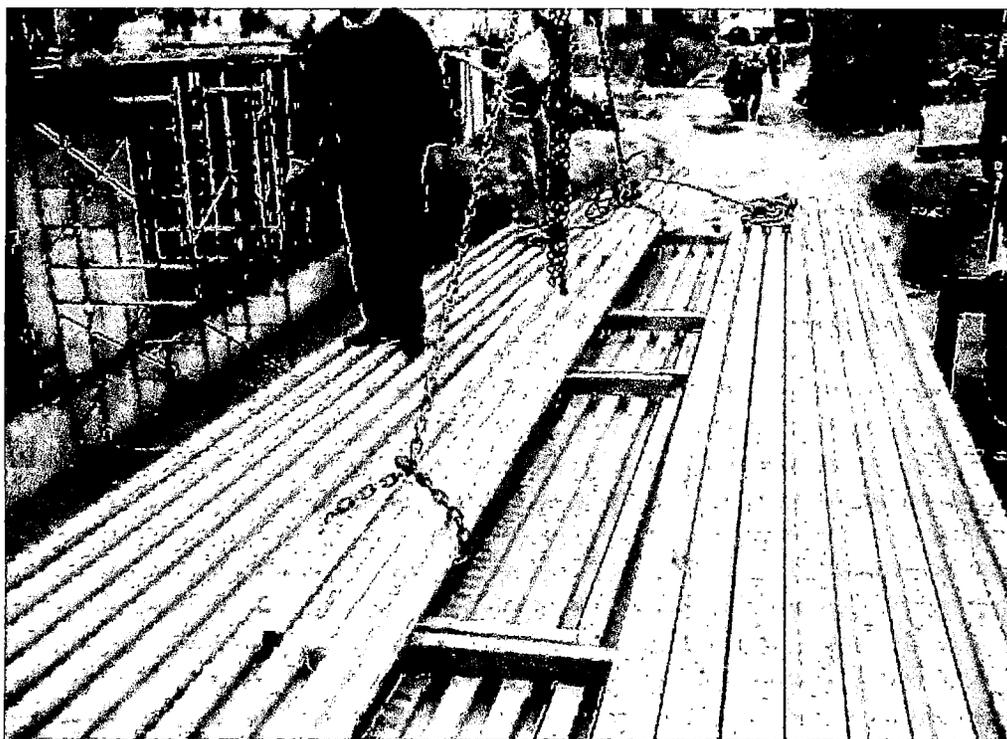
Izaje realizado con Herramienta de Izaje FIRTH
